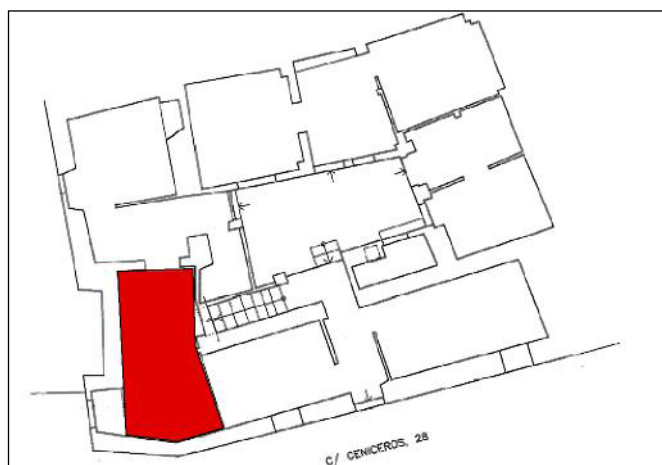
Localización del sondeo en la planta baja del edificio. Dimensiones 4,50 x 1,90 m.
